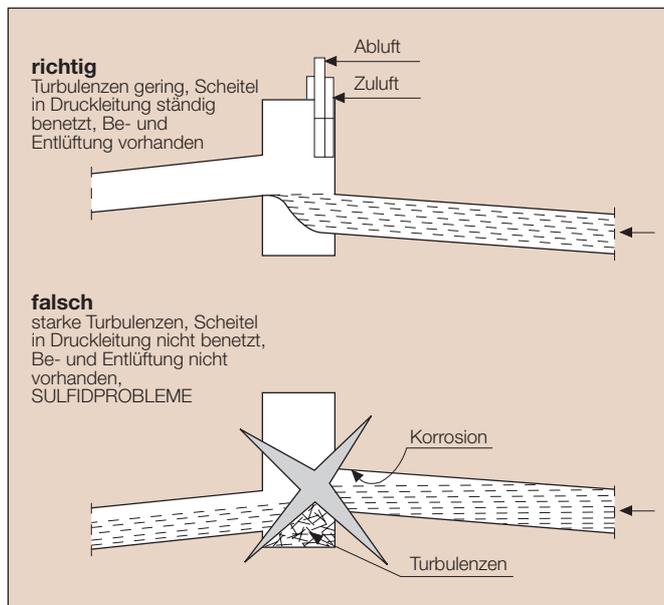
Übergabeschacht am Ende einer Druckleitung [2]
